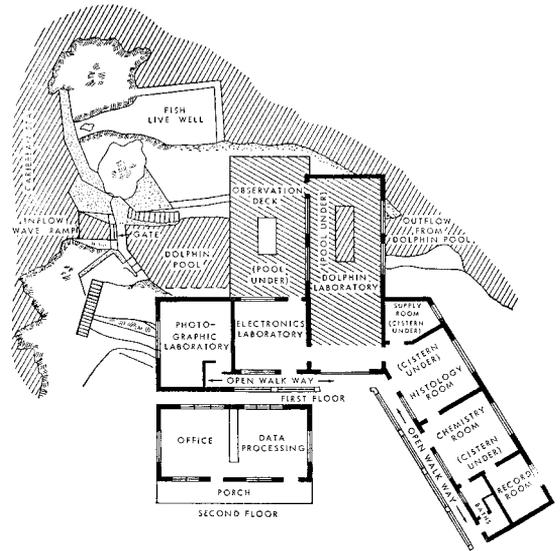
Grundriss des Dolphin Point Laboratory auf St. Thomas
